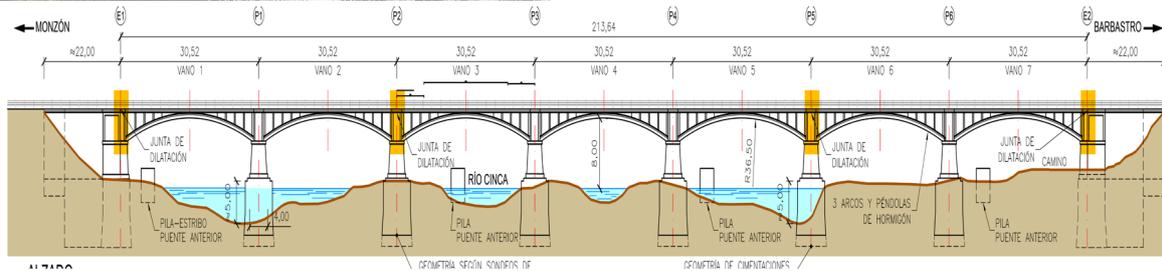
Secciones dotadas de aparatos de juntas de dilatación.
